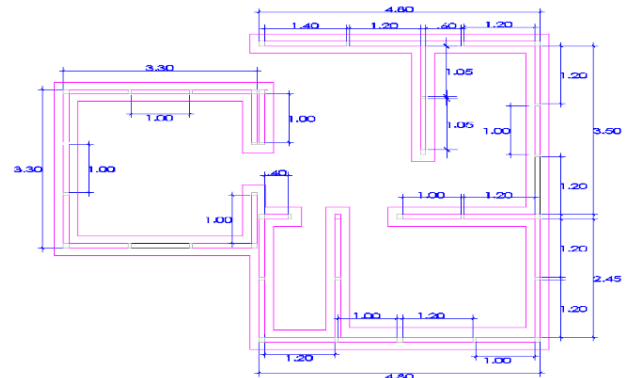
Dimensiones del cimiento corrido de la vivienda modular (Fuente: Propia)
